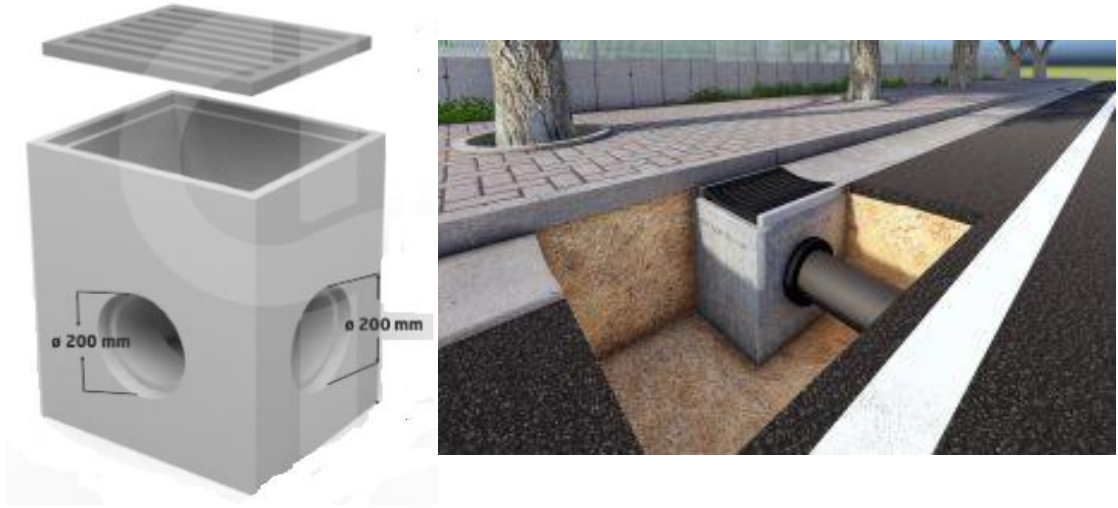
Örnek şebeke yağmur suyu ızgara planı
